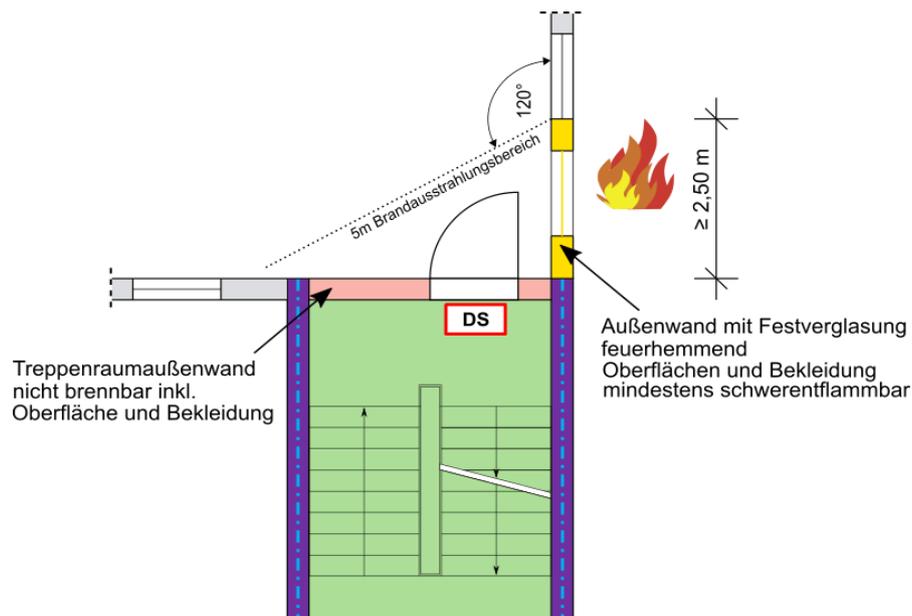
Prinzipskizze (Grundriss) - Ausgang eines notwendigen Treppenraumes in einer Gebäudeinnenecke mit über Eck angrenzenden Fenstern – Variante 2
